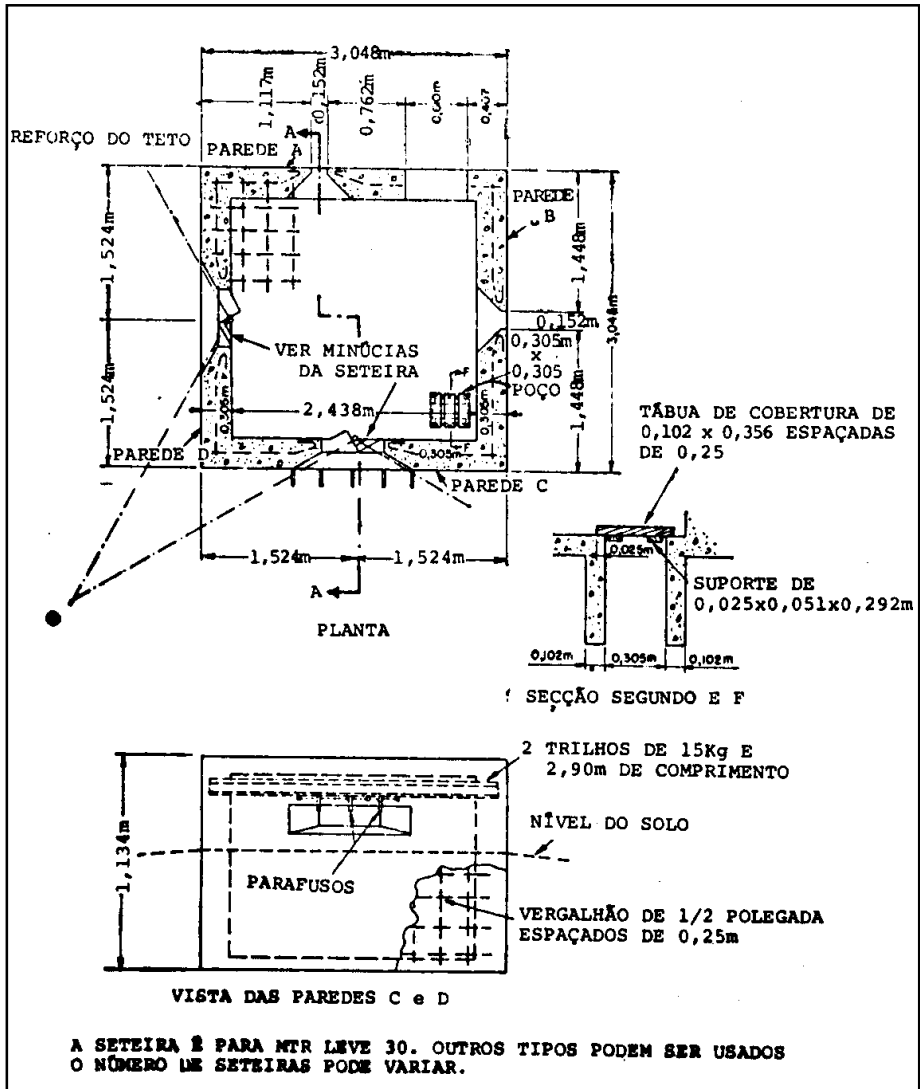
Planta de casamata quadrada, de concreto armado, para metralhadora
